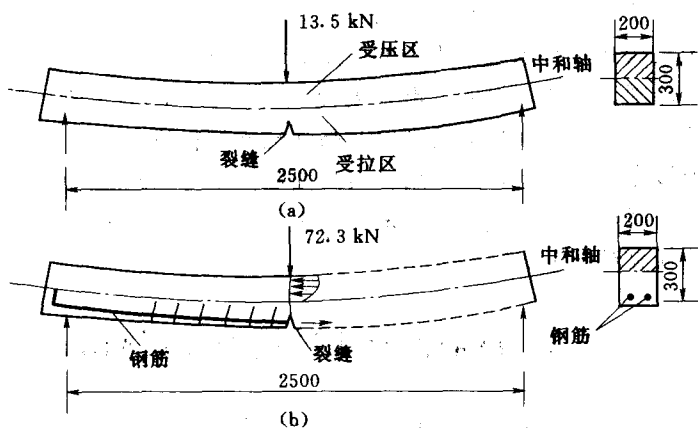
混凝土及钢筋混凝土简支梁的承载力 (尺寸单位: mm)
